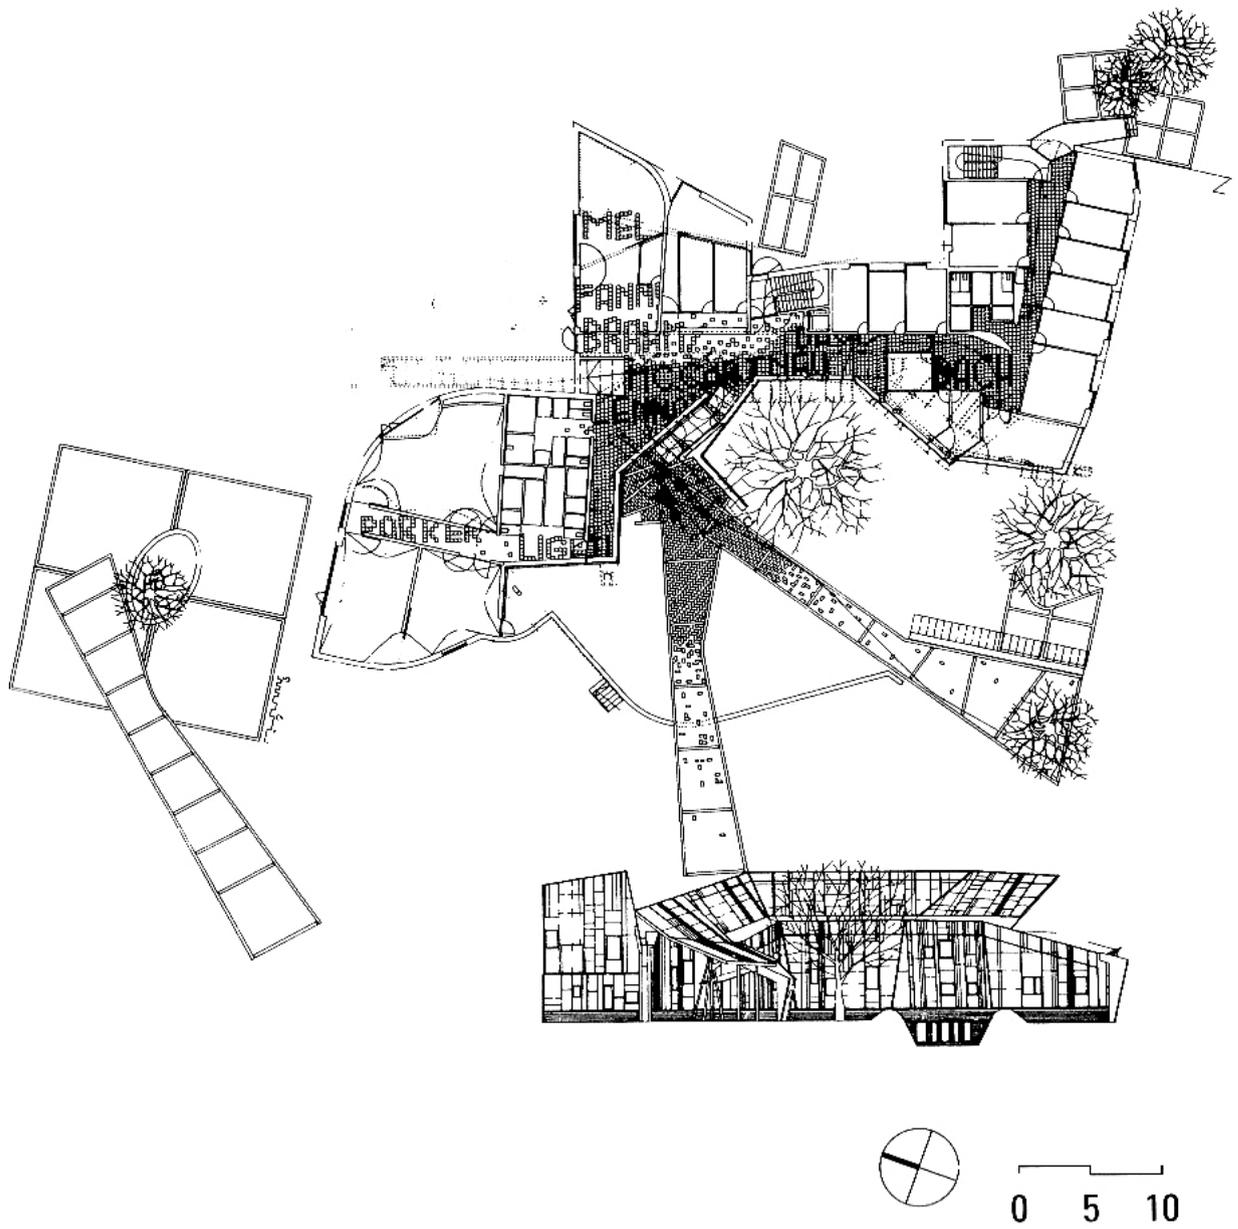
| Planta baja y fachada de la Escuela de Música de Hamburgo.
